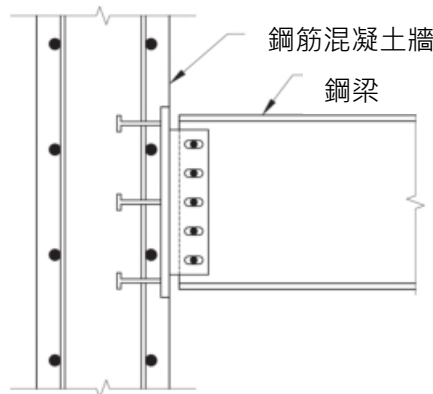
垂直載重下鋼梁與鋼筋混凝土牆之剪力接合
